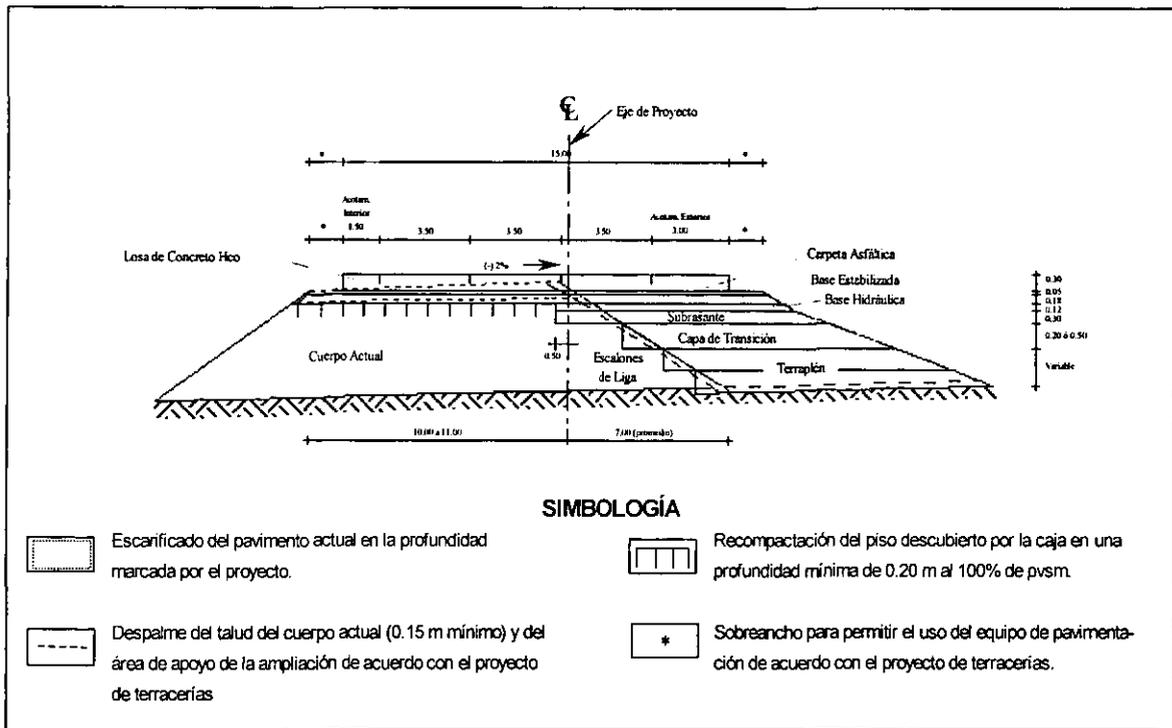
Sección tipo cuando la línea de desplante de la losa de concreto hidráulico se encuentra abajo de la superficie de rodamiento actual (<15 cm)
